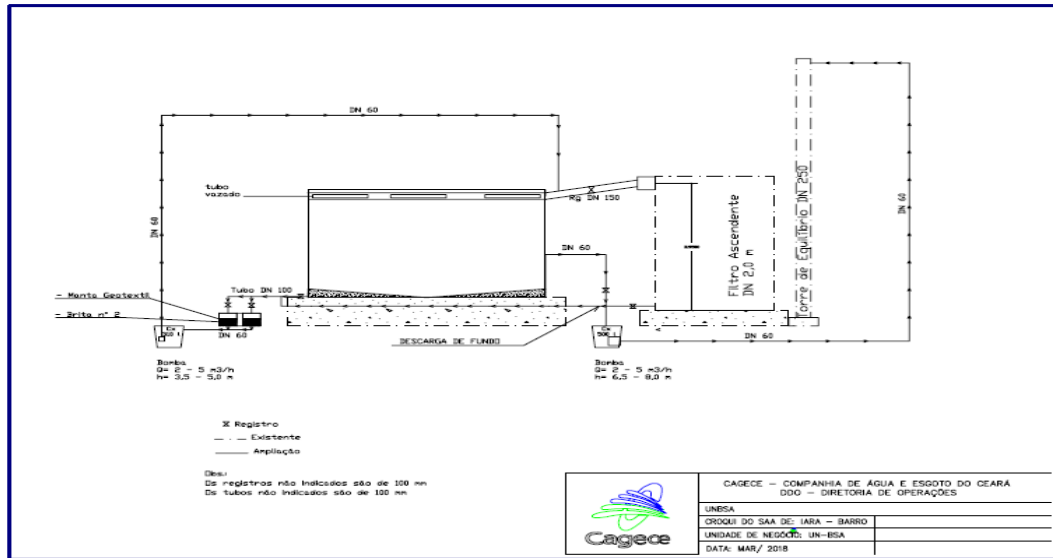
Planta Baixa e Corte da ETRG - Leitos Drenantes. Fonte: CAGECE.
